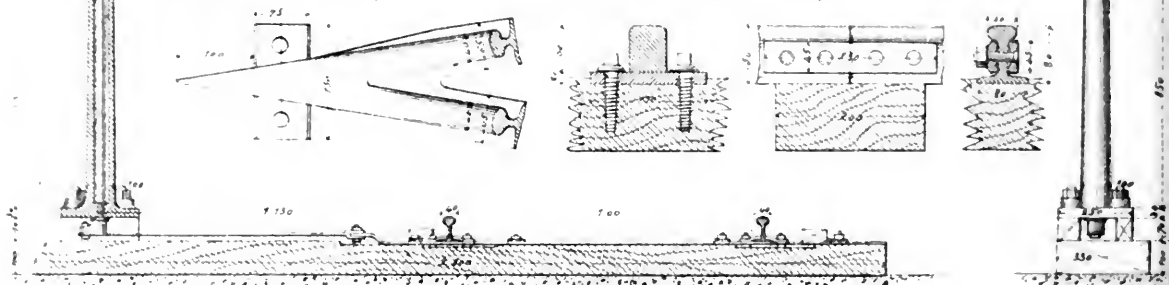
Mouvement de l'aiguillage Plan à 0,04 p^r 1^m
